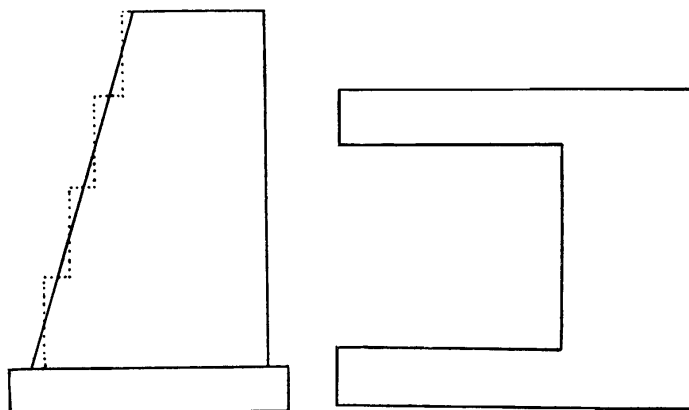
Sezione longitudinale e pianta di una spalla (Campanella,1928).
